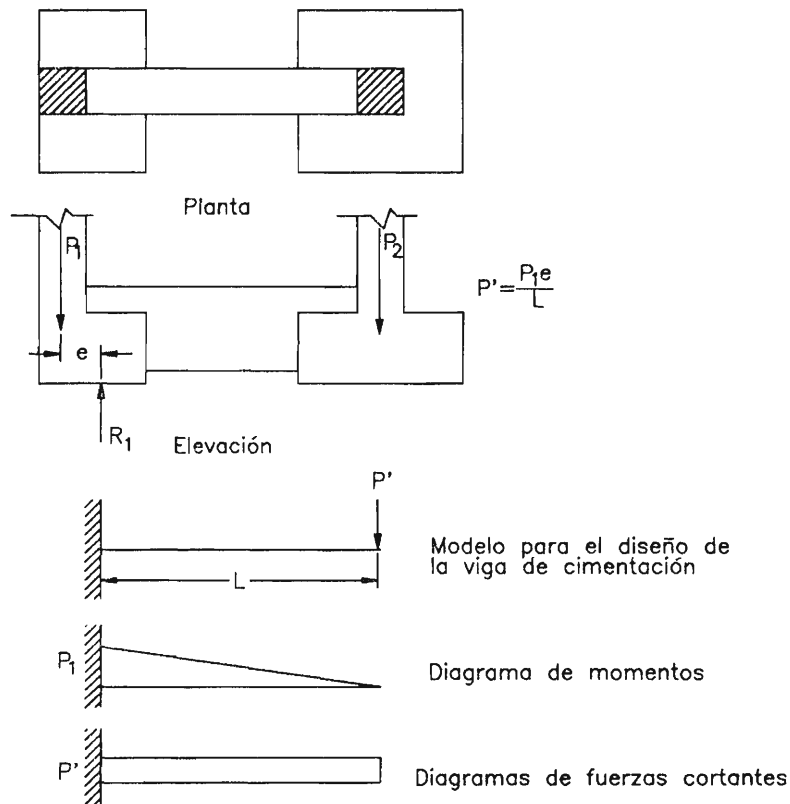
Modelo para el diseño de las zapatas conectadas
